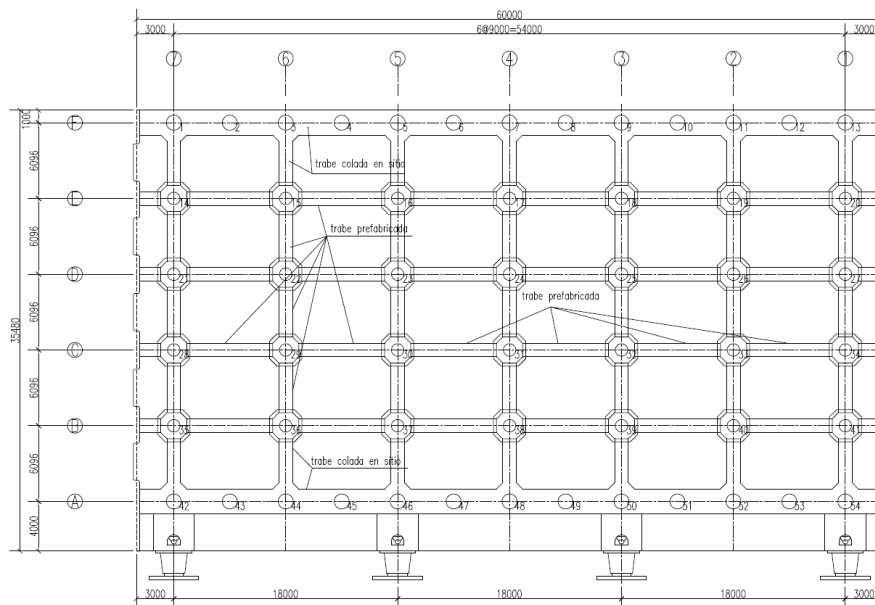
Planta de Pilas y Traveses en Módulo del Muelle
